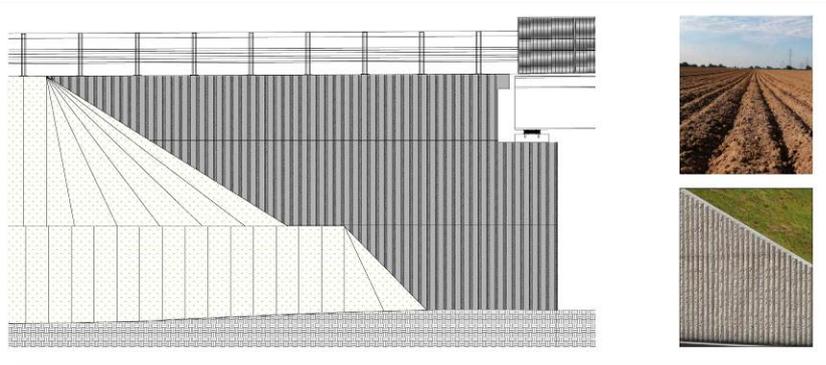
Spalla del ponte Zona Industriale San Zeno.
